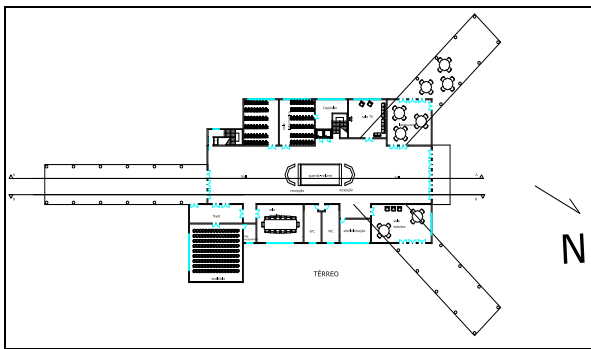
Planta do pavimento térreo do Projeto “B” (s/esc.).
